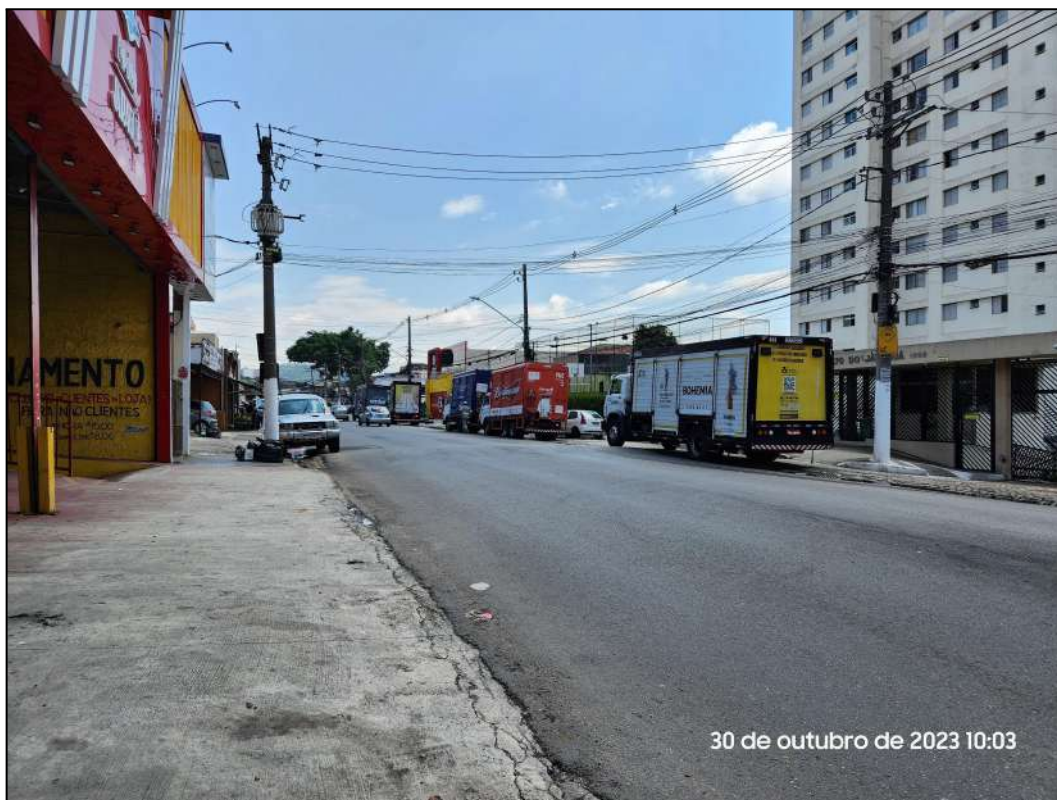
Vista da Estrada Turística do Jaraguá, no trecho considerado.
